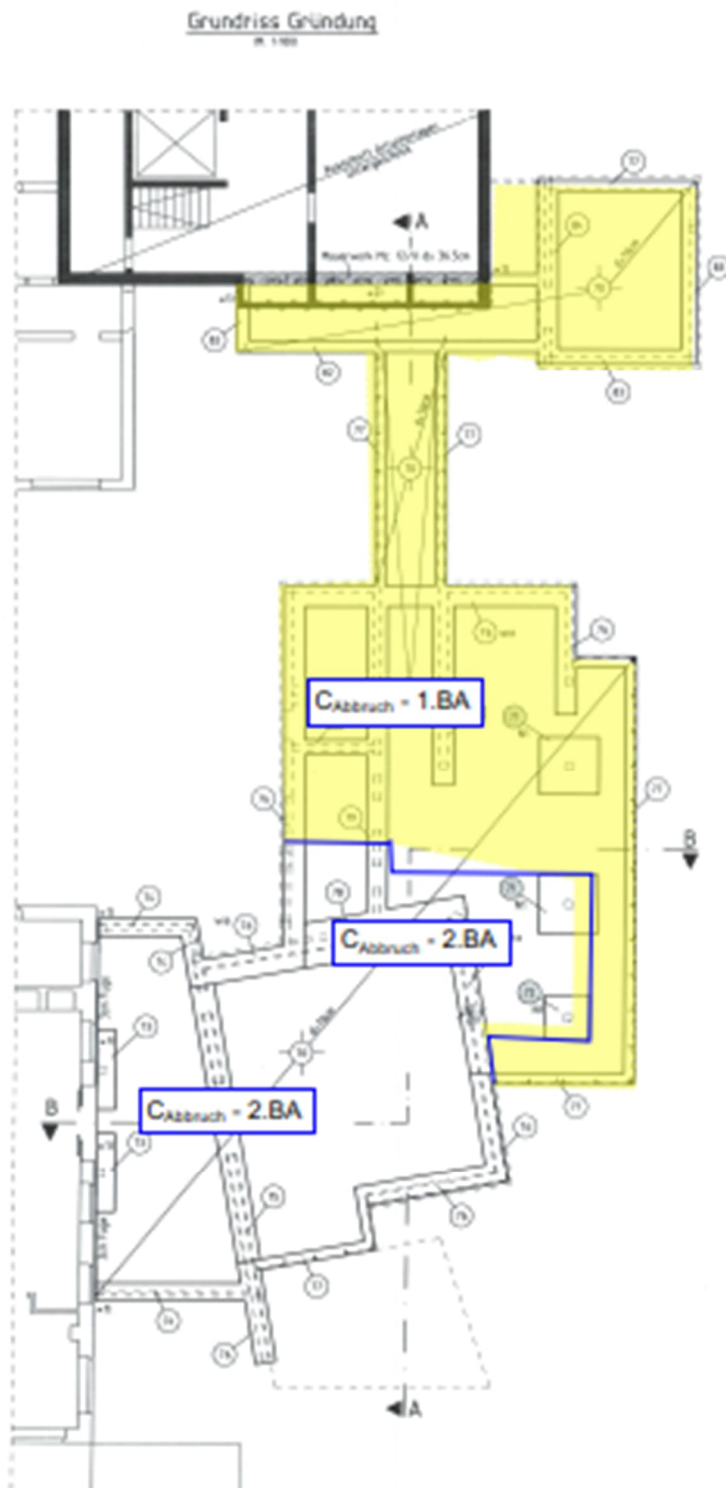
Auszug Positionsplan Grundriss Gründung P4a vom 24.02.2003
